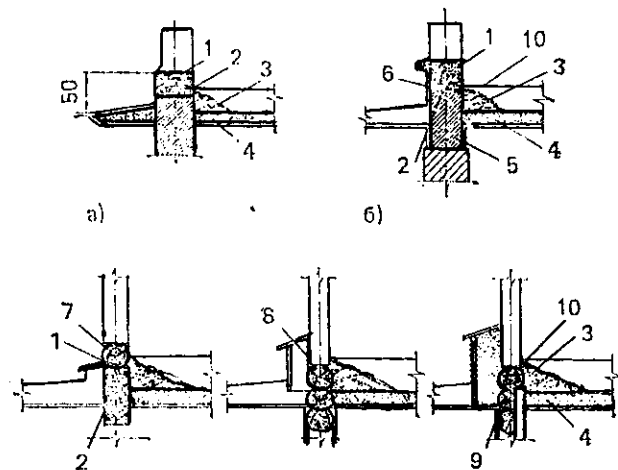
Надфундаментные конструкции а — цоколь для каменных стен при ленточном фундаменте; б — то же, при столбчатом фундаменте; в — цоколь из кирпича; г — цоколь из бревен для деревянных стен; д — утеплитель-заевалника 1 — кирпич керамический; 2 — гидроизоляция; 3 — отсыпка; 4 — подготовка; 5 — ростверк; 6 — цементная штукатурка; 7 — обвязка; 8 — забирка из бревен; 9 — забирка из пластин; 10 — пол
